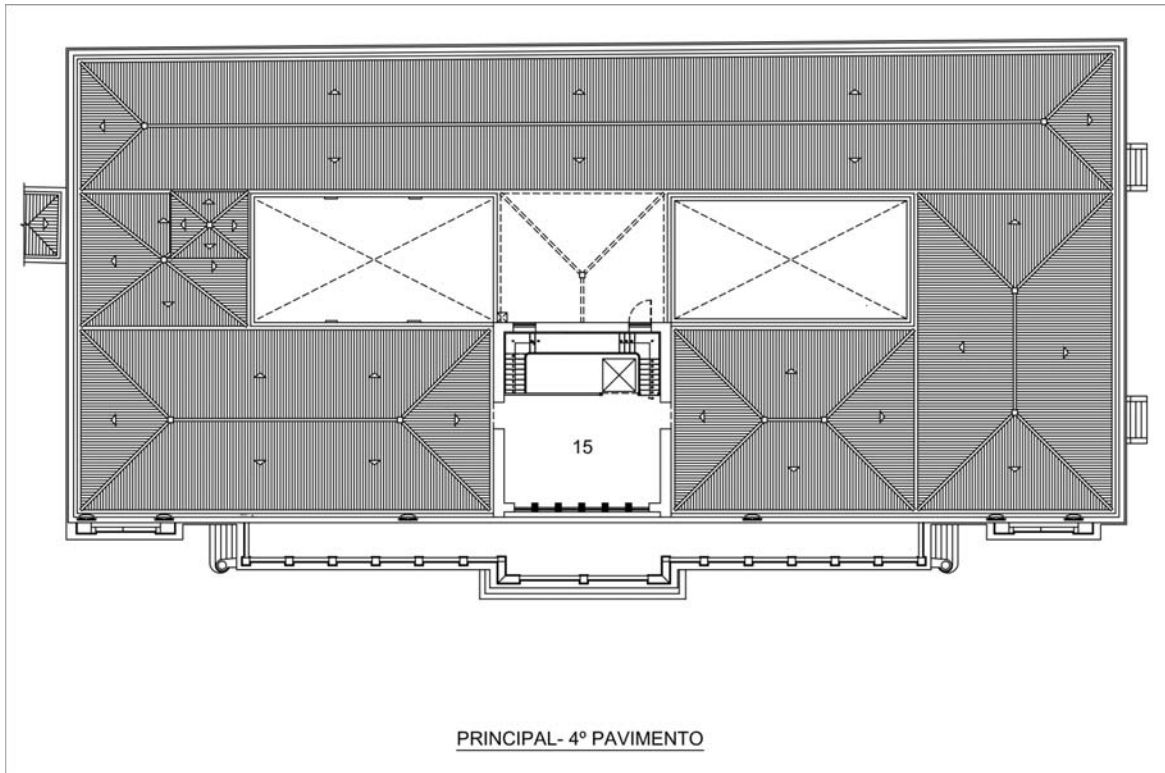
Planta hipotética do 4 Pavimento do prédio principal – hotel – sem escala.
